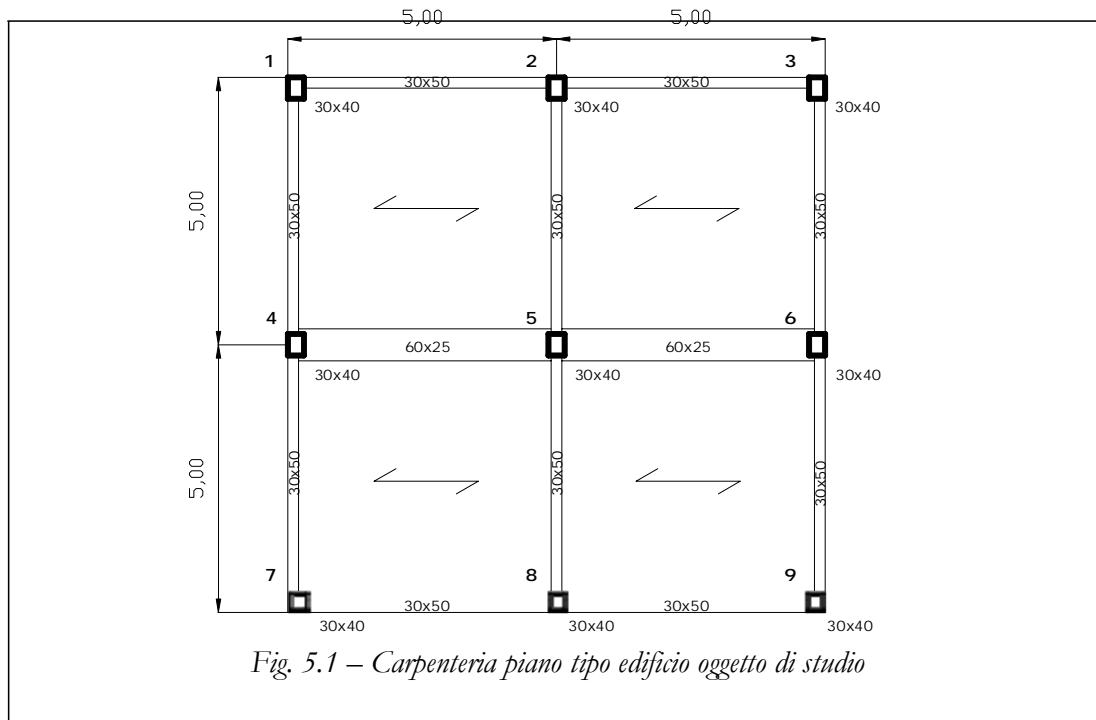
Carpenteria piano tipo edificio oggetto di studio
